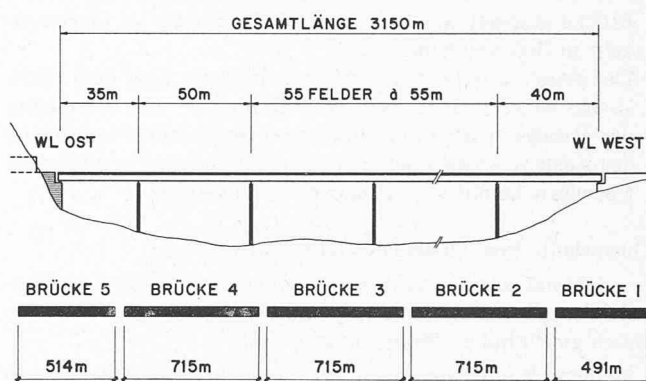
Brückeneinteilung in Längsrichtung, Spannweiten und Brückenabschnitte
